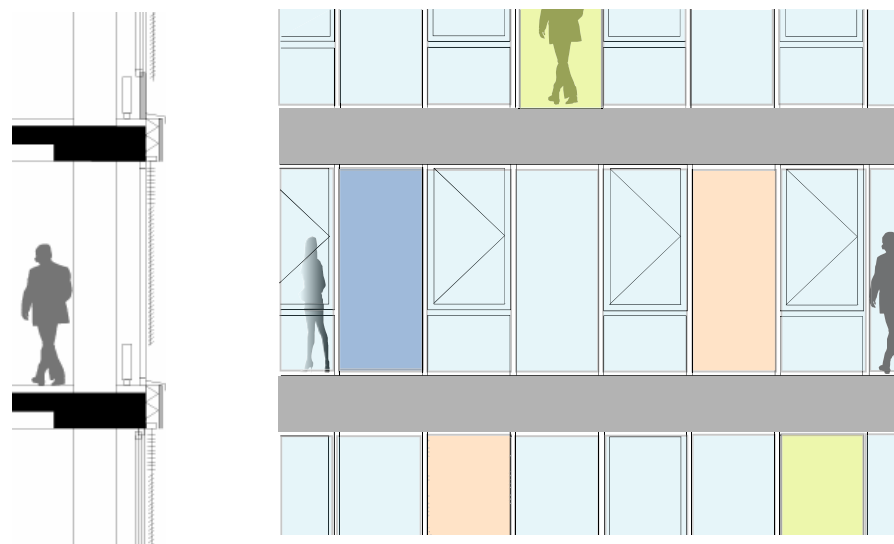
Variante 4 Schnitt / Ansicht Fassade
